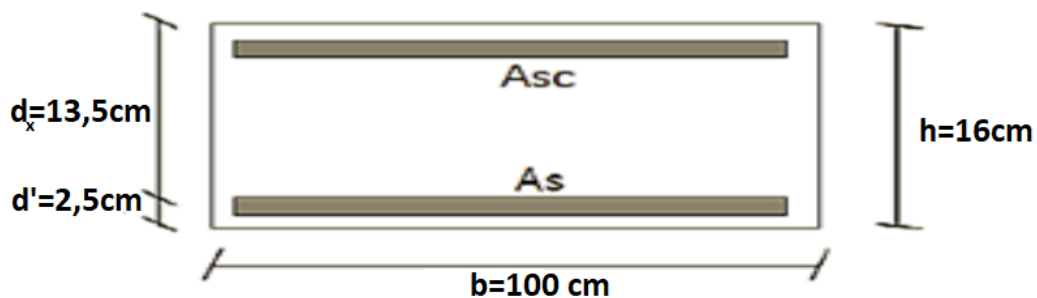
Dimensions de la section transversale de la dalle pleine
